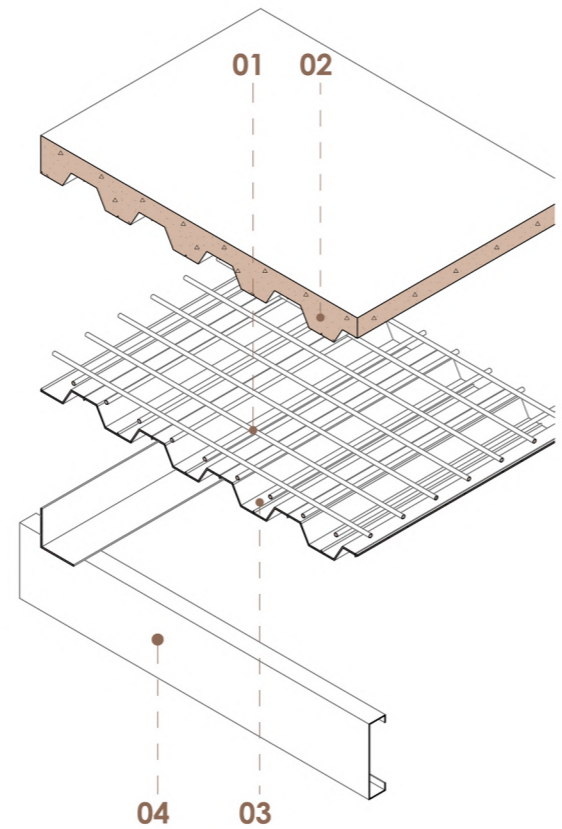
Orden de colocación de los elementos en la losa con placa colaborante
